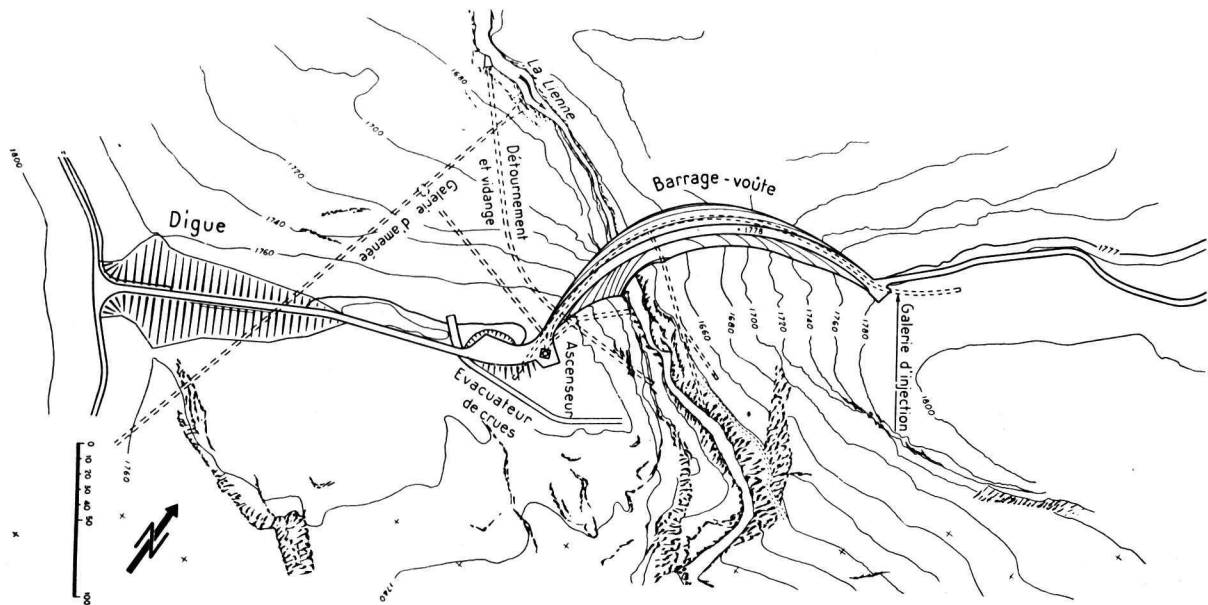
Plan de situation du barrage de Zeuzier et de la digue de Proz-Riond
